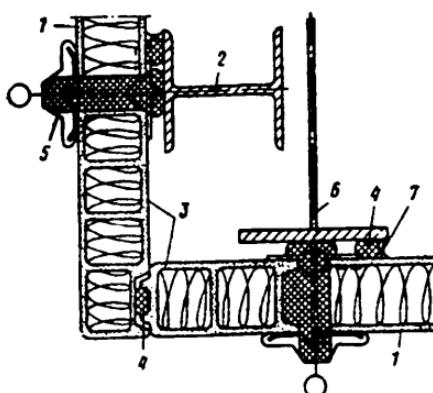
Размещение доборных экструдиционных панелей в углу стены и сопряжение стен с колоннами:
